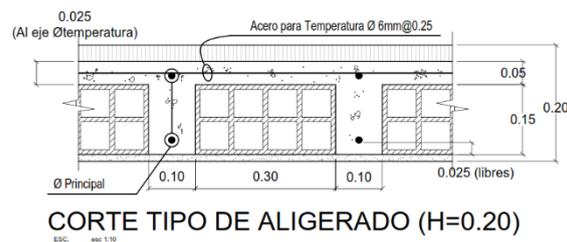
Detalle del aligerado. Fuente: elaboración propia
